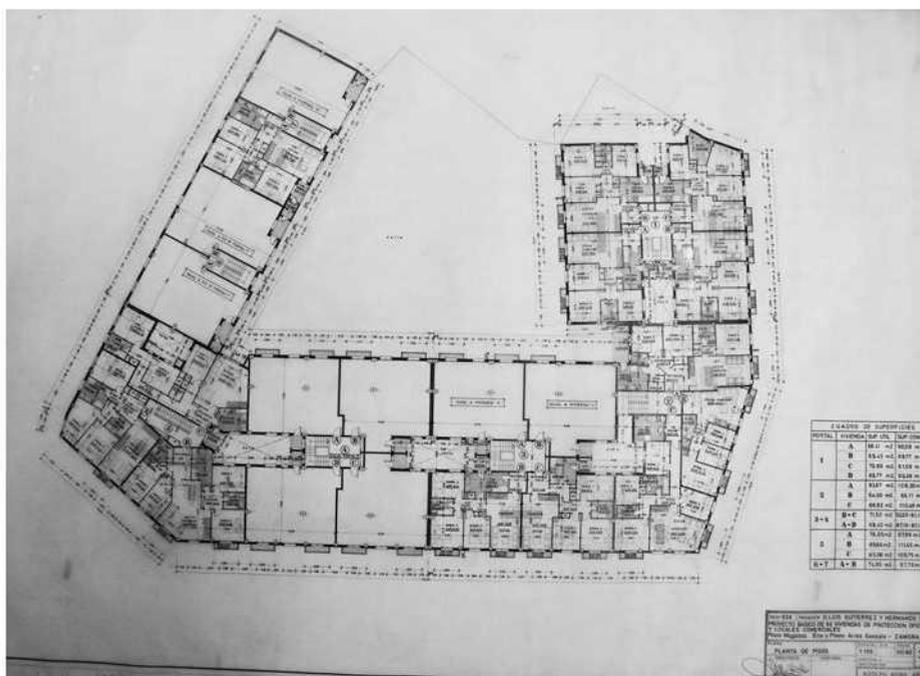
Edificio “Los Soporales”. Planta de pisos. 1980.
